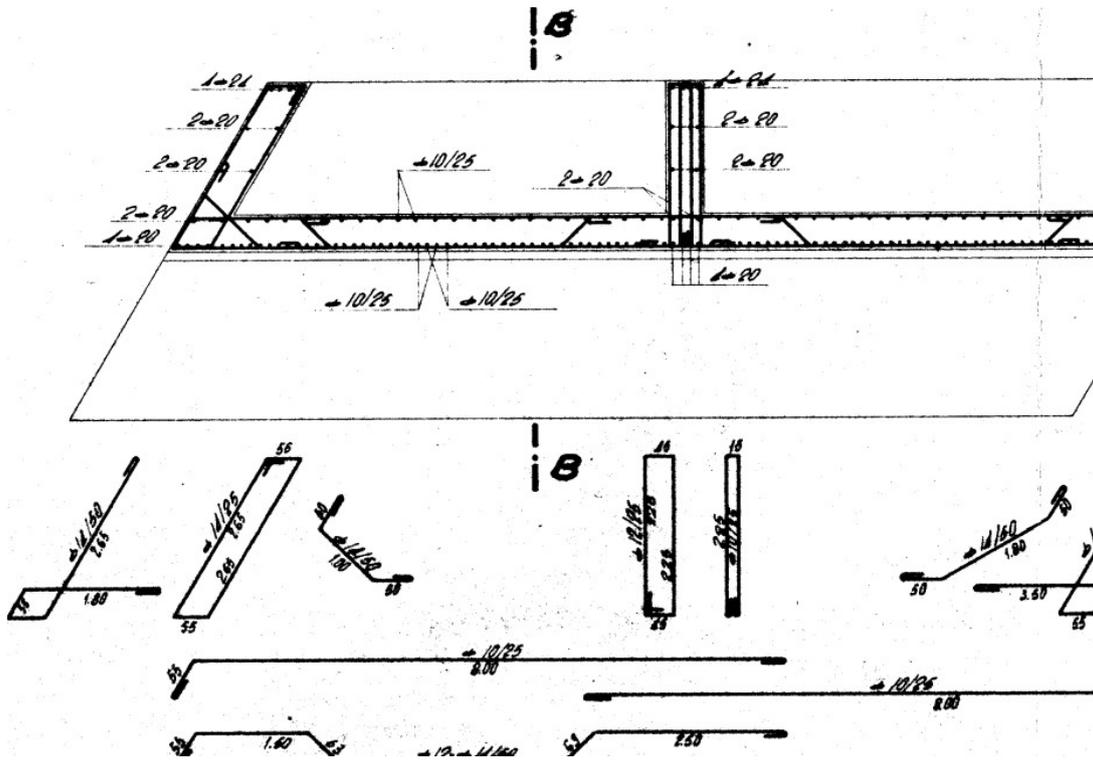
Documento as-built “Sottovia Interconnessione 6 dell’autostrada A14 al km 14+490” – Sezione orizzontale con armature spalla.
